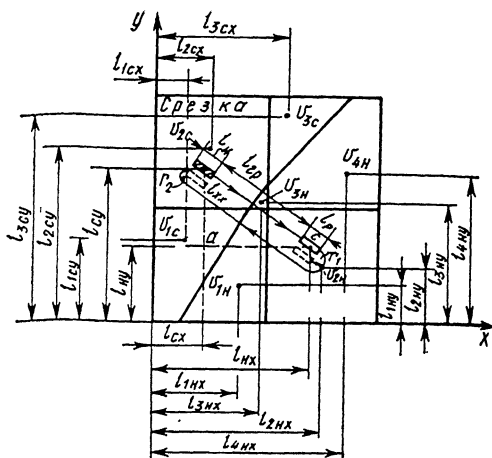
Схема планировки участка с параметрами для определения расстояния перемещения грунта скреперами с участка срезки на участок насыпи
